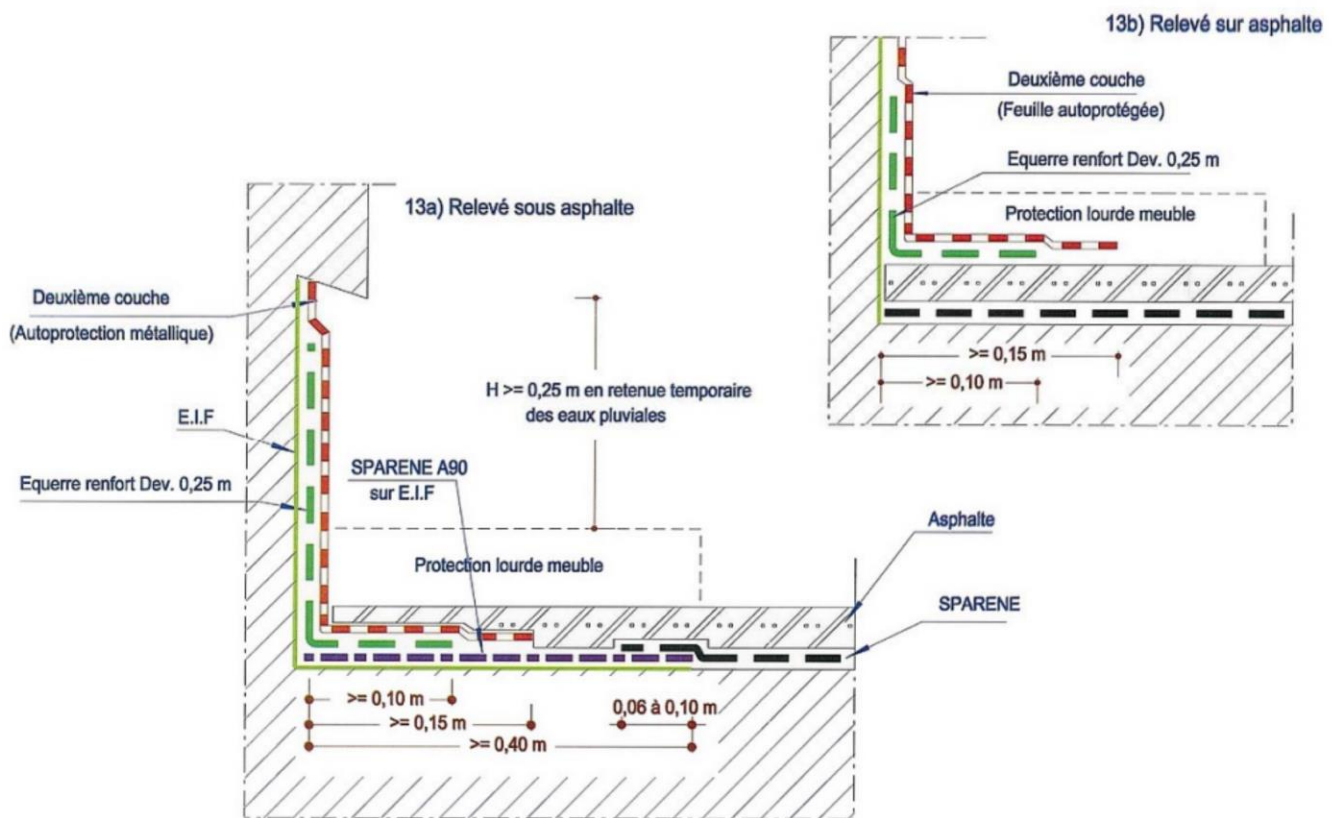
Terrasses inaccessibles – Retenue Temporaire des eaux pluviales
